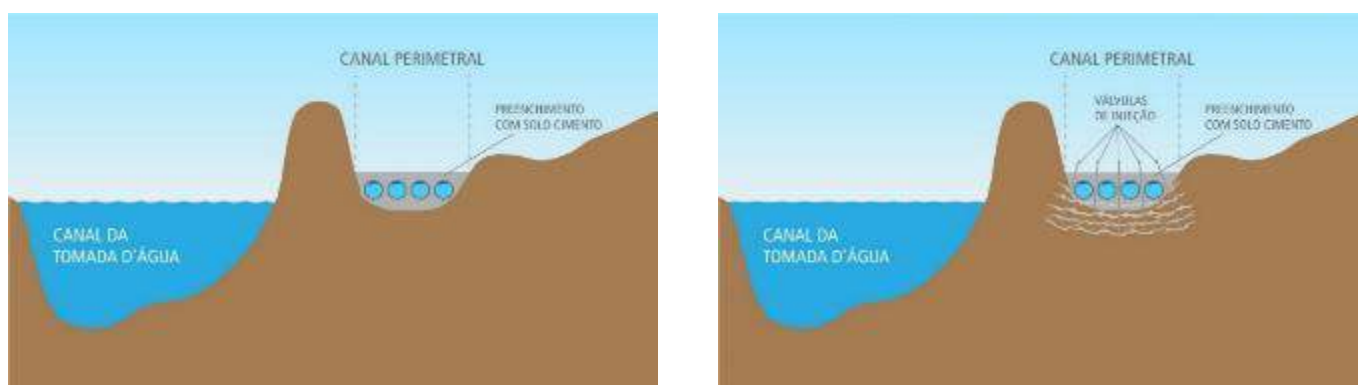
Caso 10 – Travessia do canal Perimetral – Preenchimento com solo cimento em área do canal e injeções de consolidação
